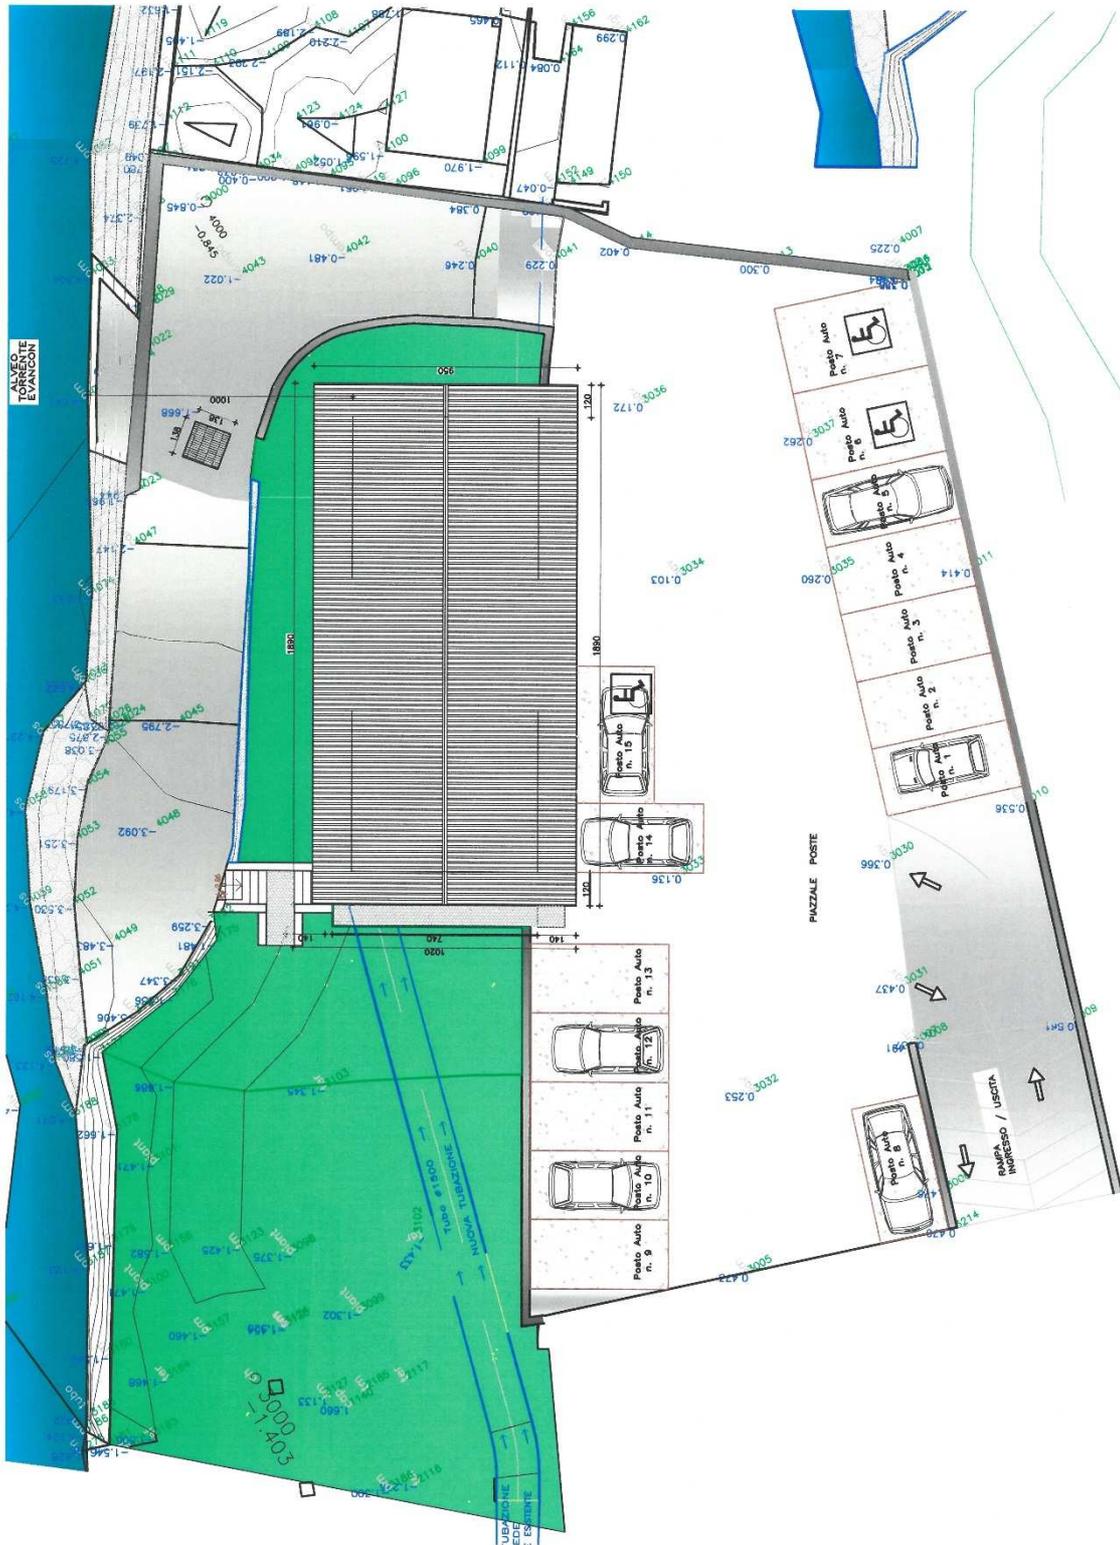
Planimetria fabbricato centrale nel progetto autorizzato
